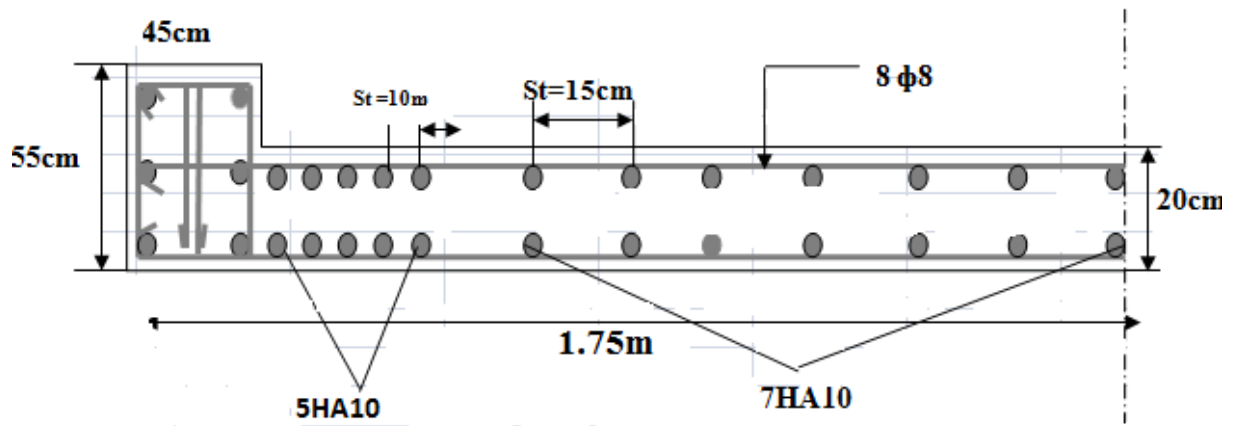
Ferraillage Disposition des Armatures dans Le Voile.
